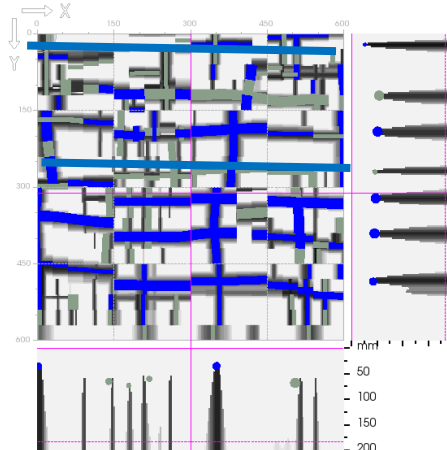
Poutre Pt01 – Travée 4 à mi-travée
